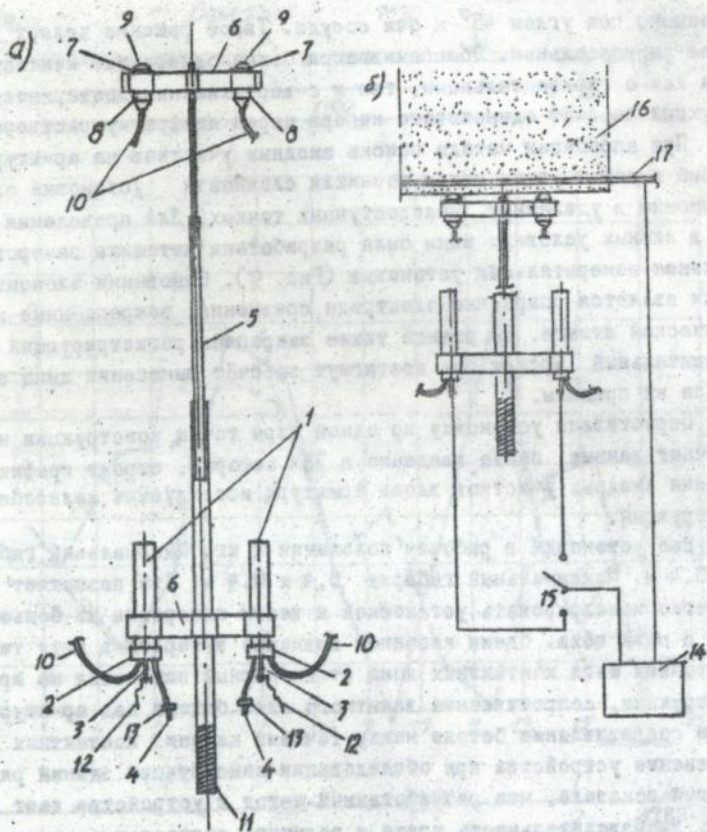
Устройство для коррозионных обследований железобетонных конструкций а-схема устройства; б-схема подключения
